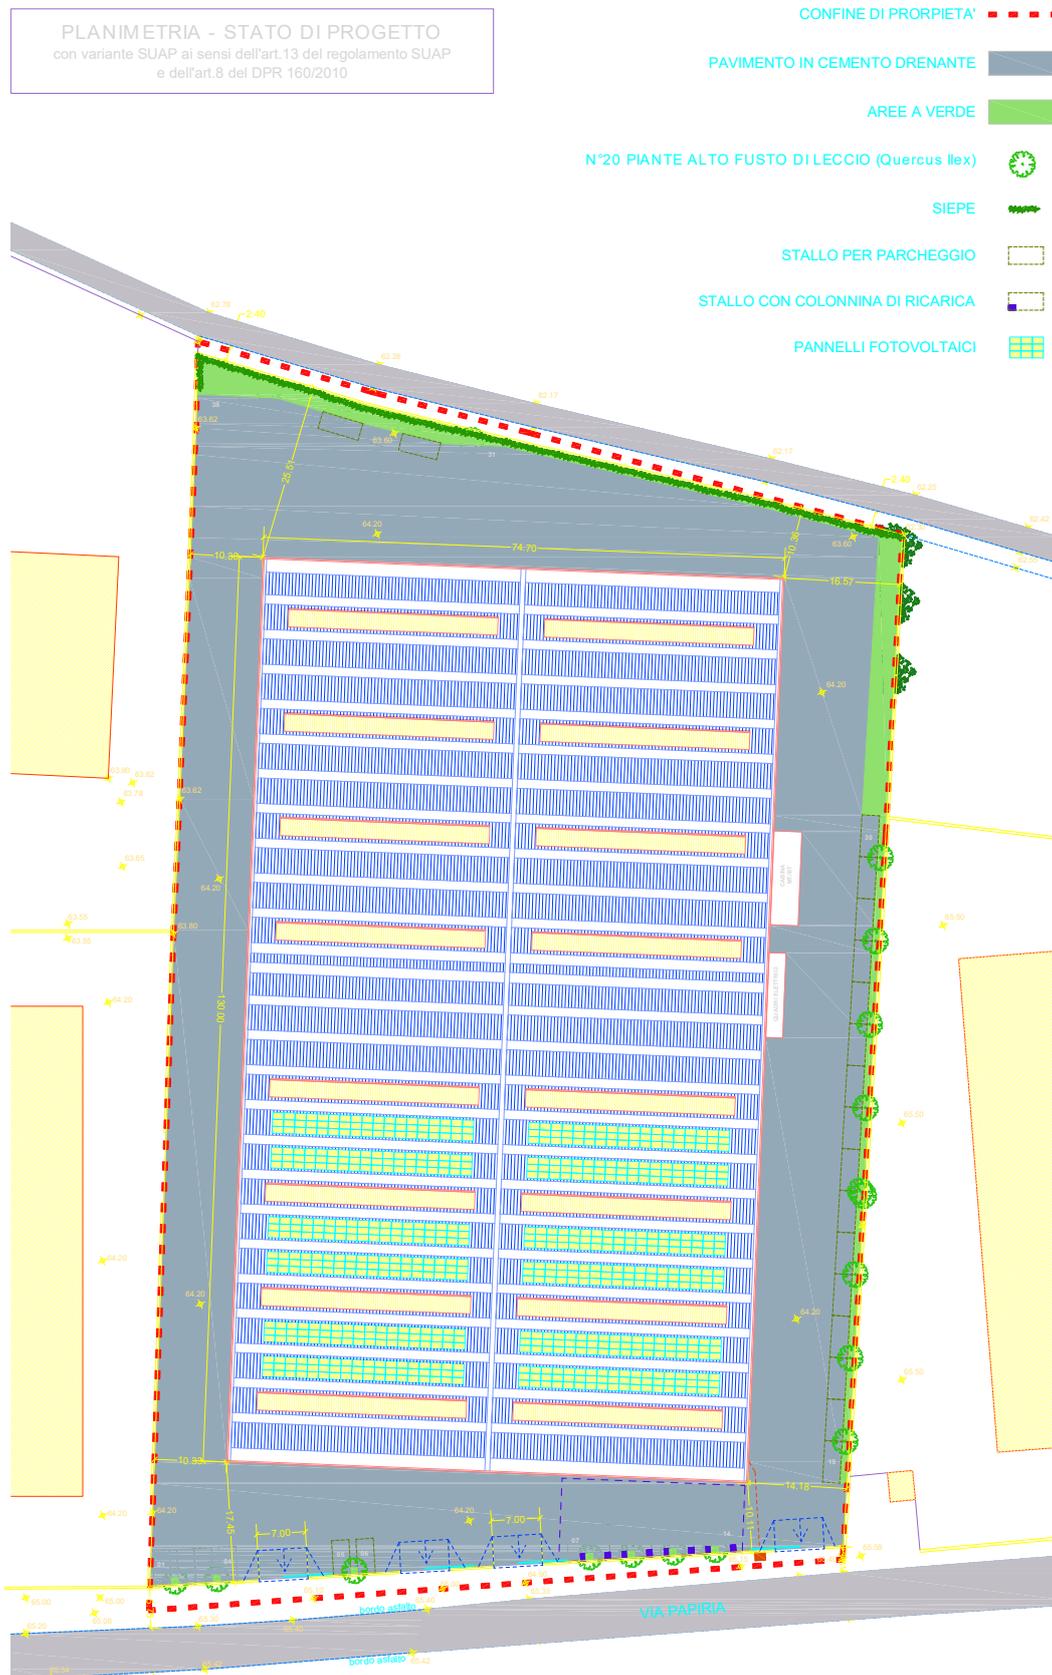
progetto planimetria generale POST OPERAM con evidenza delle sorgenti individuate
